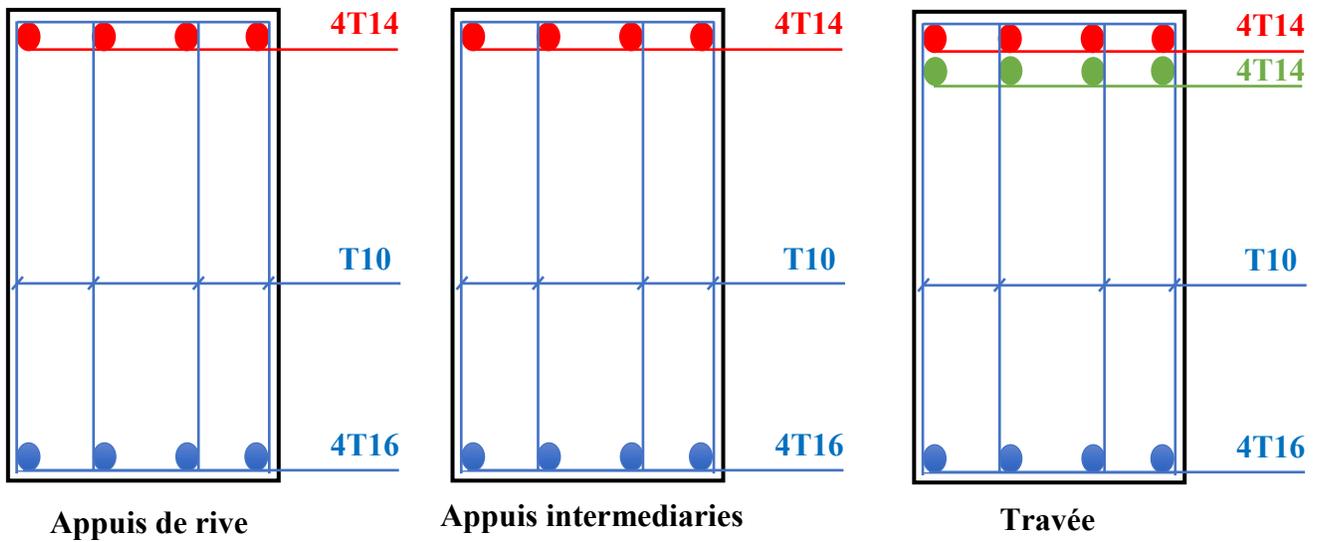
Ferrailage de la poutre de libage (sens Transversale)
